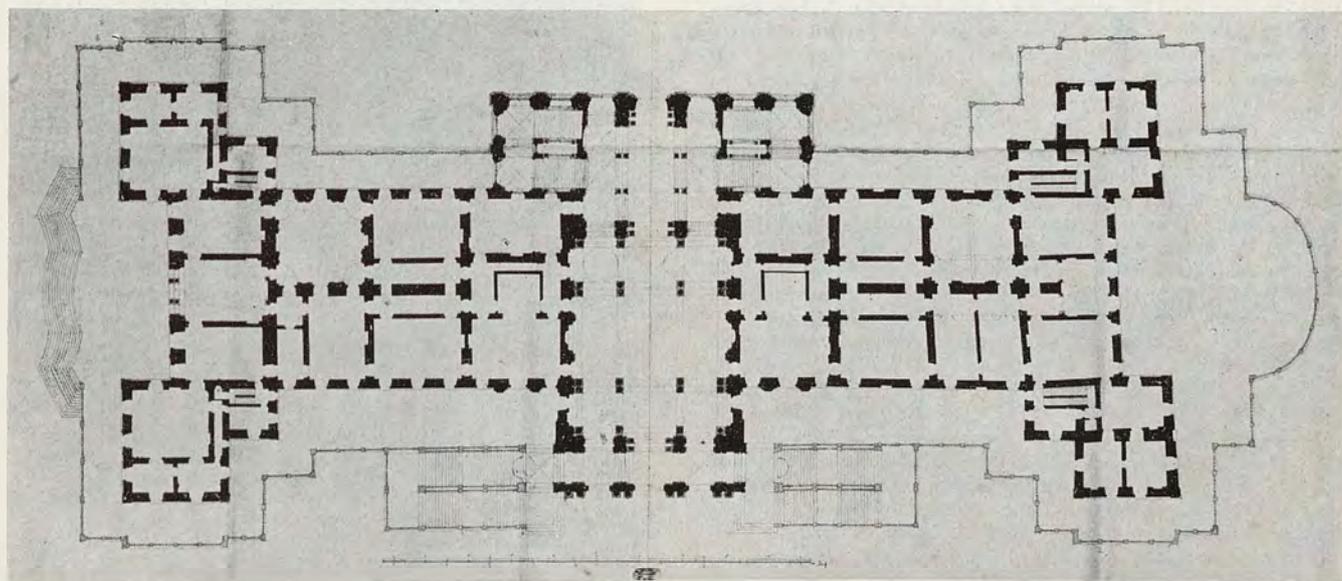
Planimetria secondo il progetto di Juvarra, 1718, Torino, Archivio di Stato.
